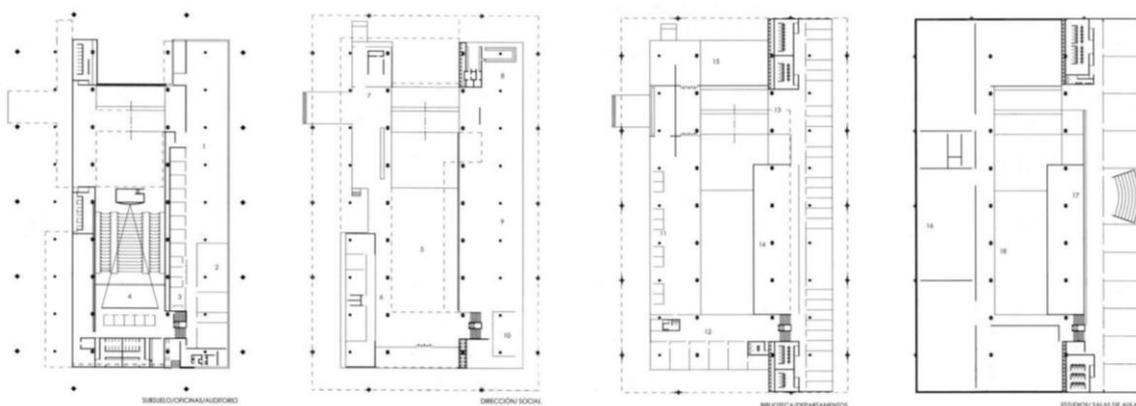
Facultad de Arquitectura: plantas, trama estructural
